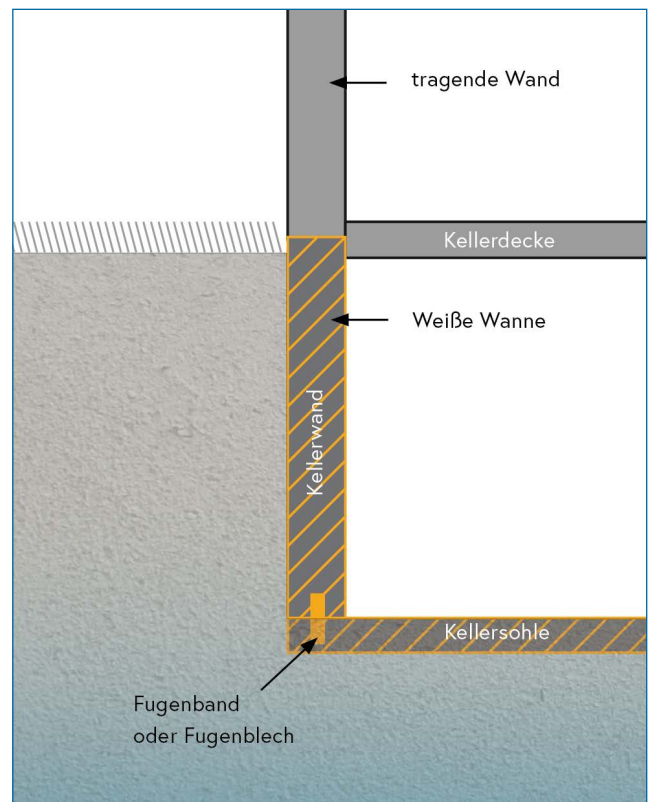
"Weiße Wanne". Außenwände und Bodenplatte bestehen aus wasserundurchlässigem Beton.
